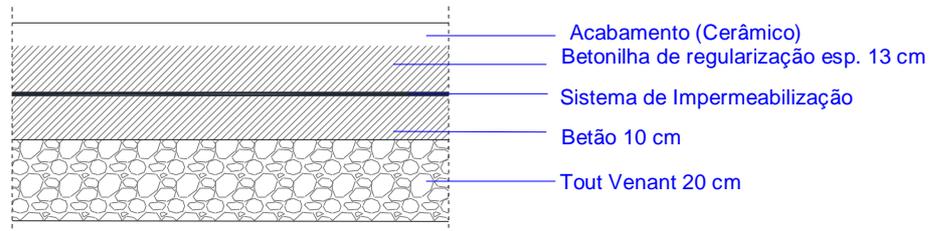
Pormenor Pavimento térreo (cedida pela empresa)
